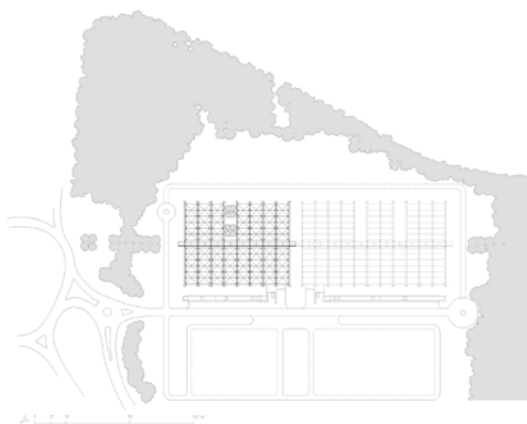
Plano de la planta de la cubierta de la fábrica Imos. Fuente: Elaboración propia.
